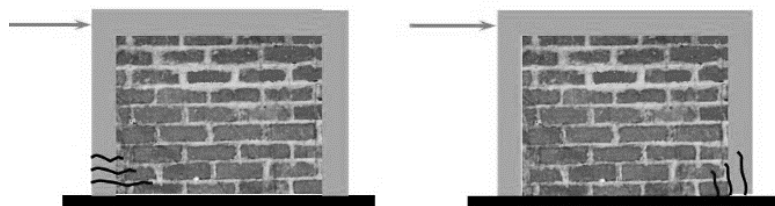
Falla por flexión en muro de mampostería no estructural (Masias, 2002).
